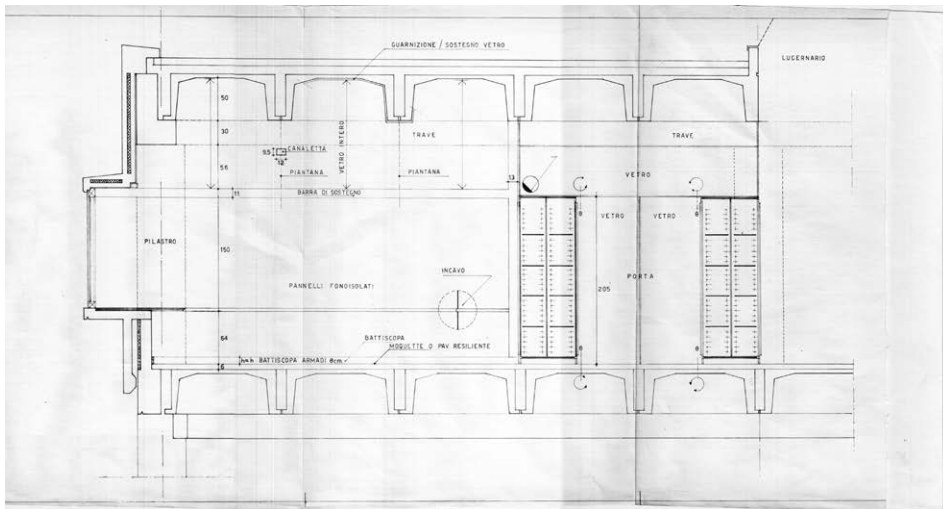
Pareti divisorie degli studi. Si notano la facciata a pannelli e i tegoli del solaio. ASTO-Borini, f. cemento armato 1956-83, m. 907.
